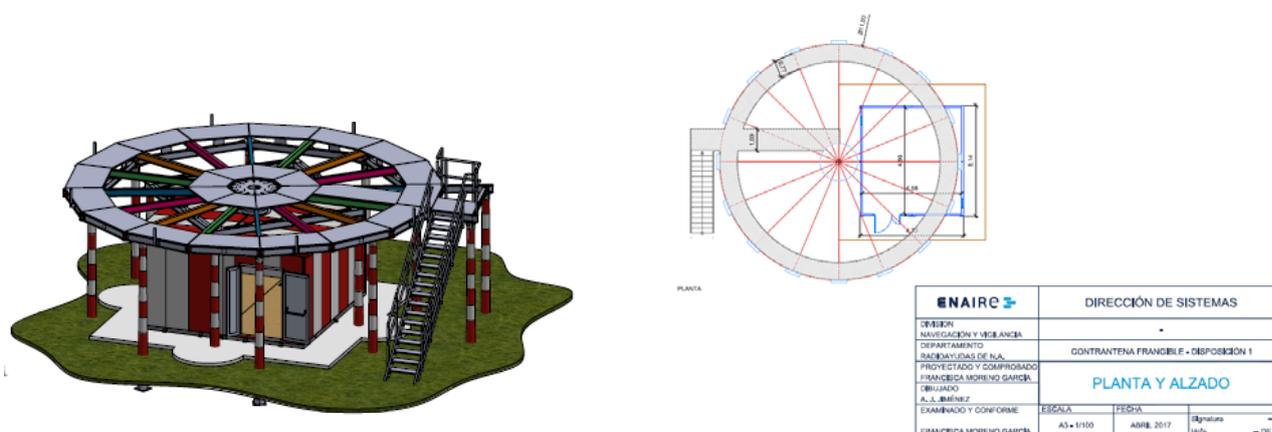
Instalación el nuevo edificio VOR con su contraantena frangible. Fuente: Proyecto constructivo
